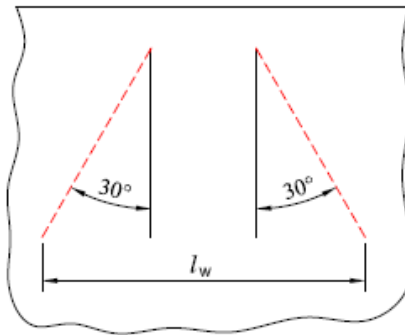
Ancho de Whitmore para conexión soldada.
